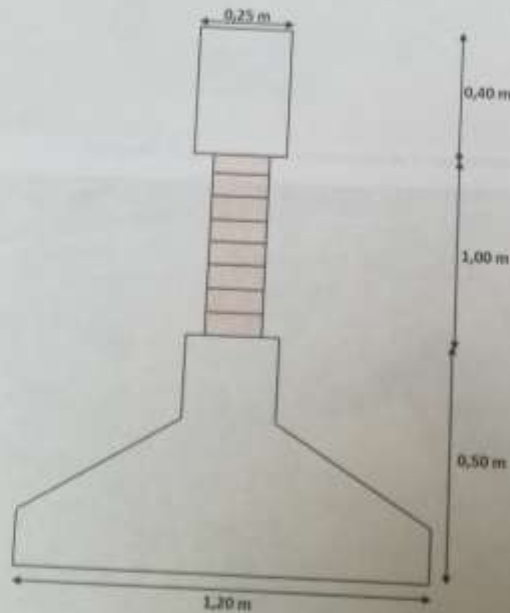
Tipo de cimentación existente conformada por zapata corrida con viga de amarre.
